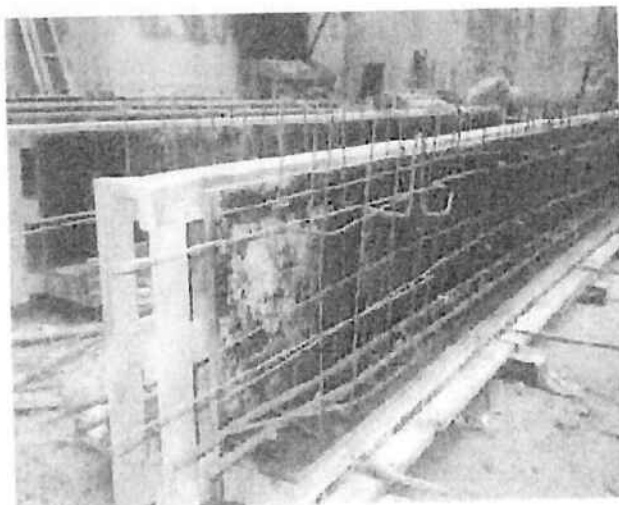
Armadura e ganchos para transporte da pré-viga
